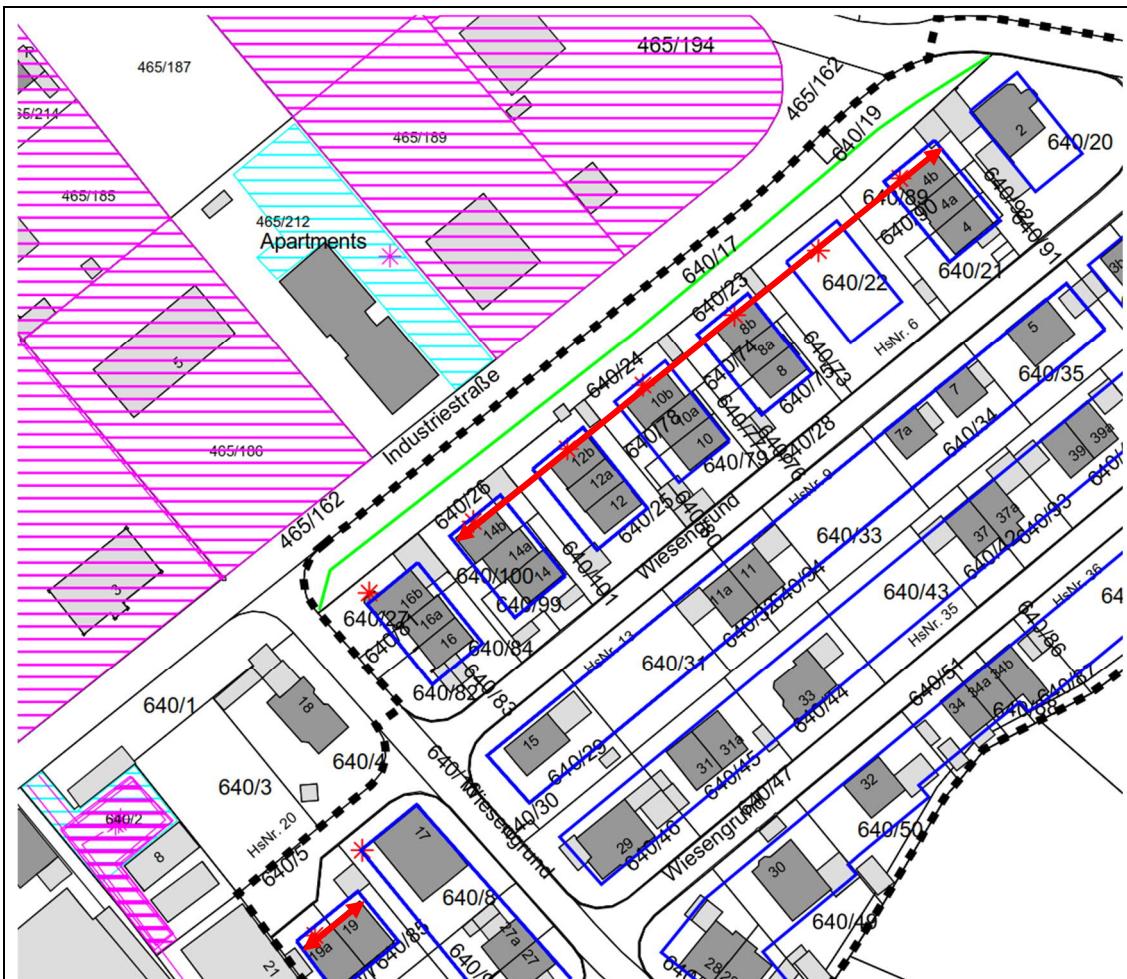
Lageplan zur vorgeschlagenen 3,0 m hohen Schallschutzwand (grün) und Baugrenzen-Zurücknahme (rot)
